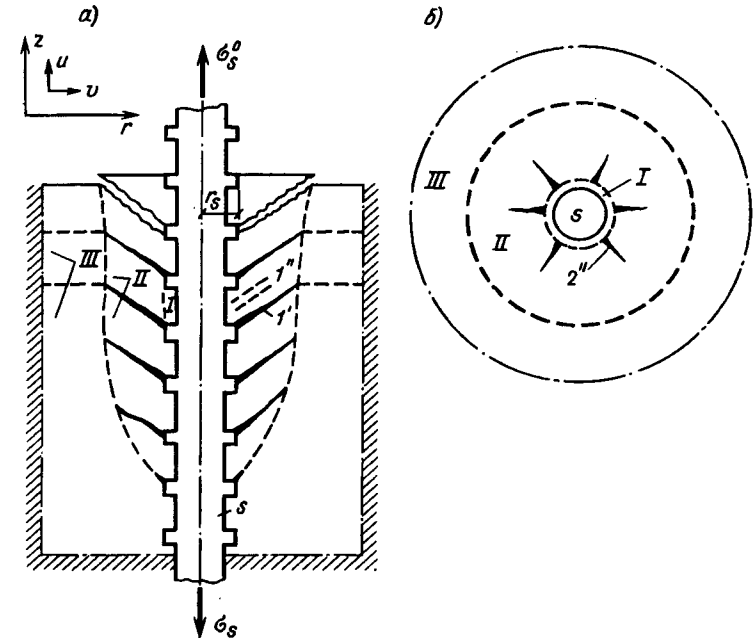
Зона сцепления арматуры s с бетоном и ее элементы
